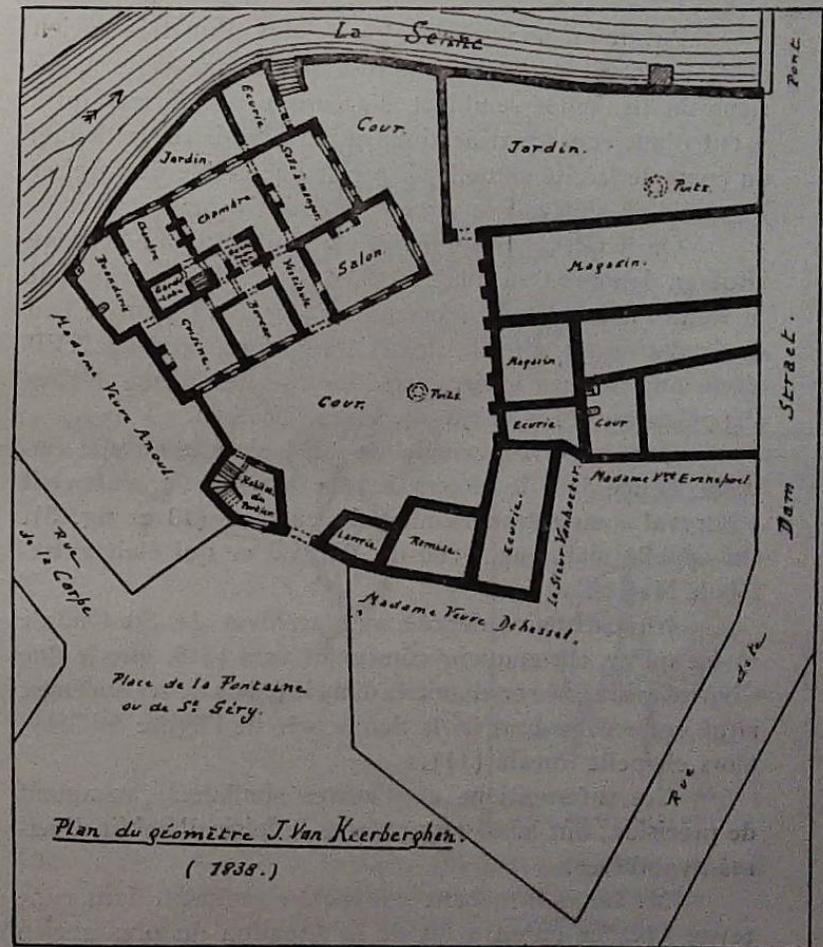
Plan de la propriété Brinck en 1838, où se trouvait le dit escalier.
